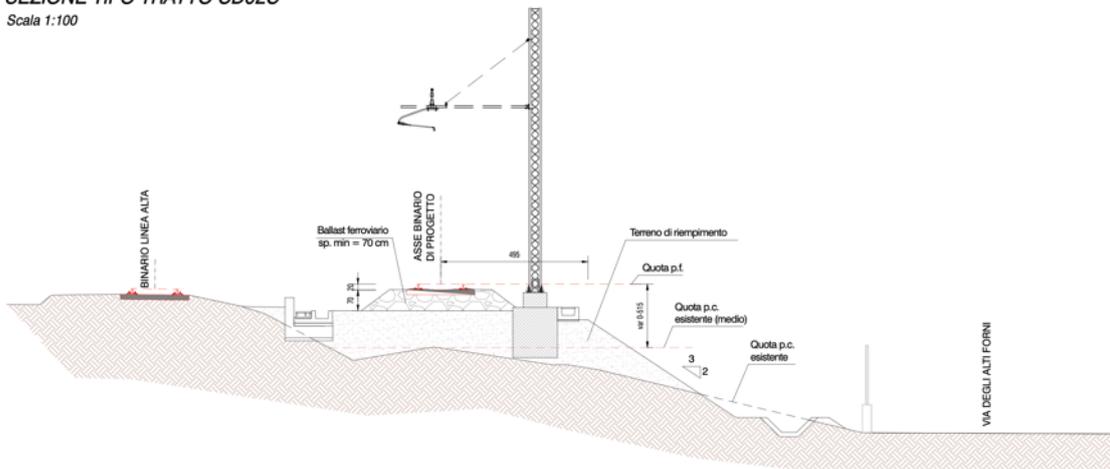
sezione tipo in rilevato (tratto CD02C)
